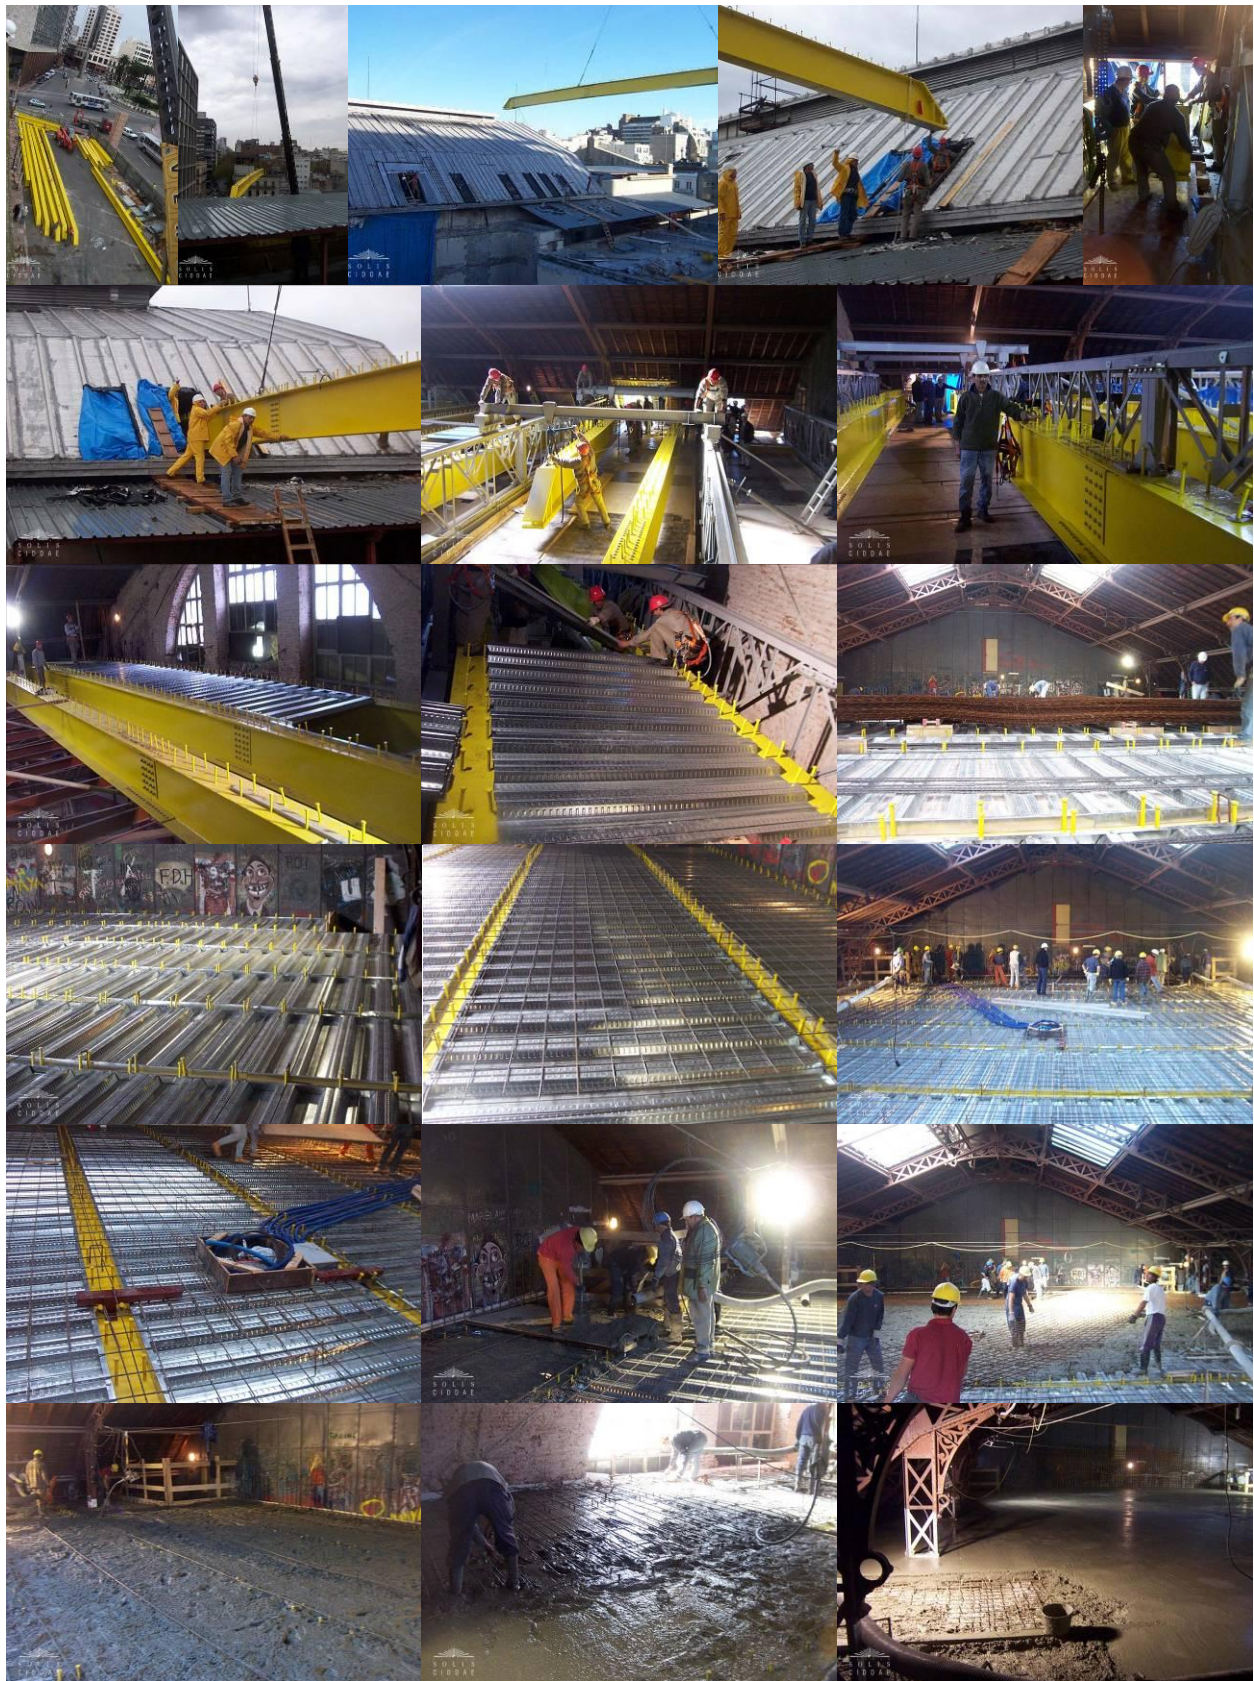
Puesta en obra de la losa de la sala de pinturas
